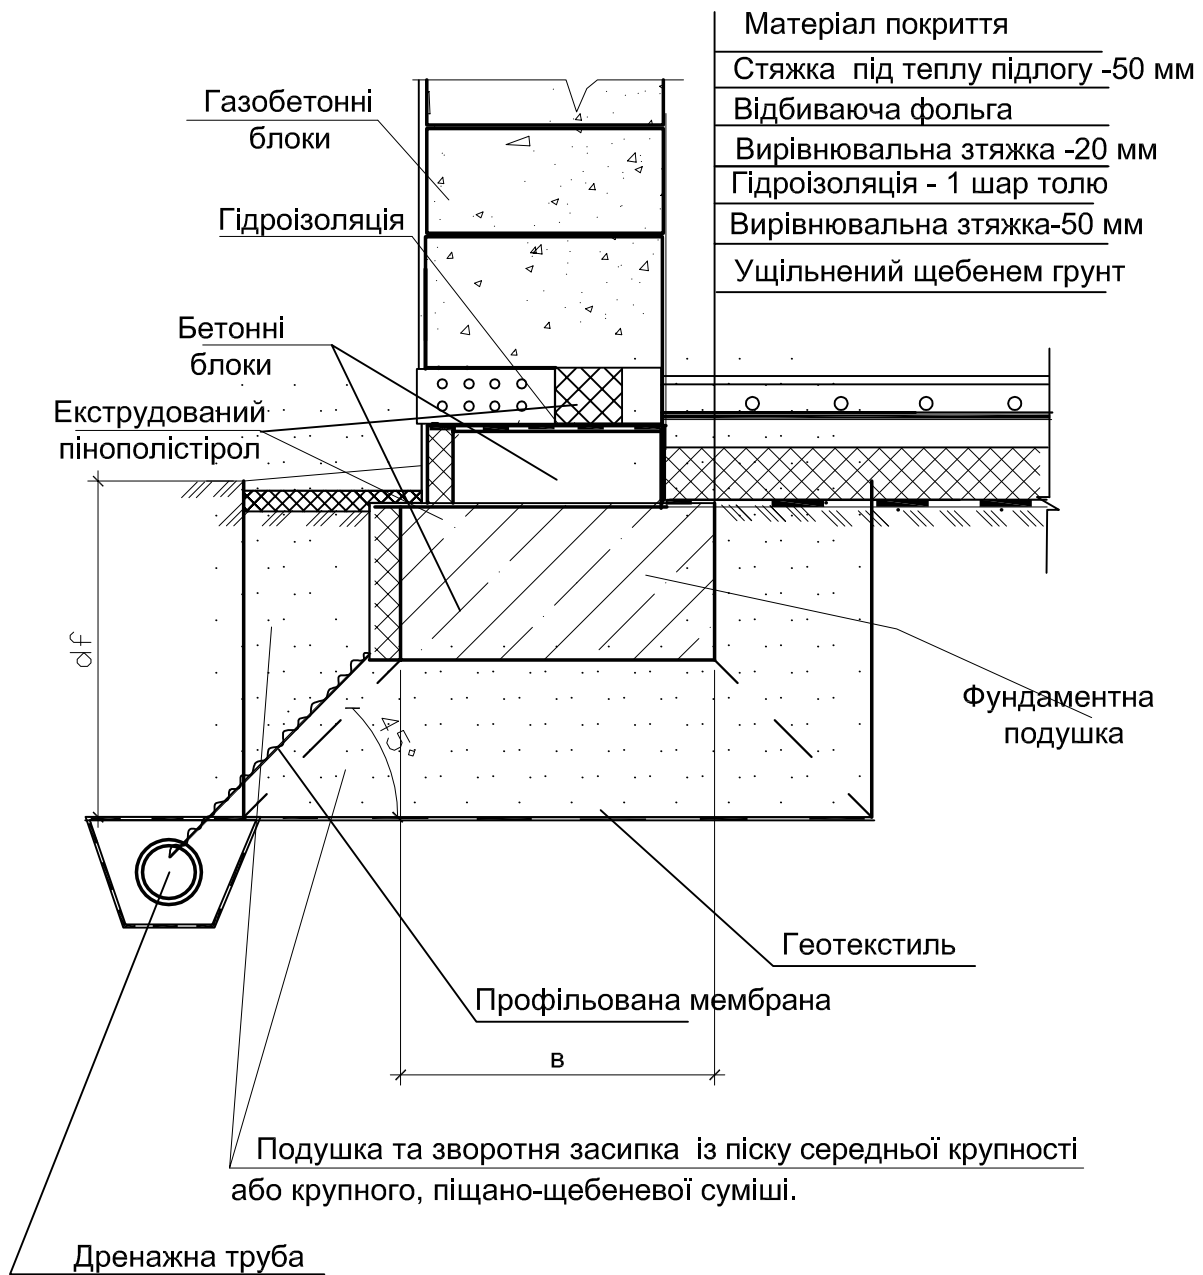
2-15. Монолітні фундаменти мілкого залягання на протиздимній подушці
